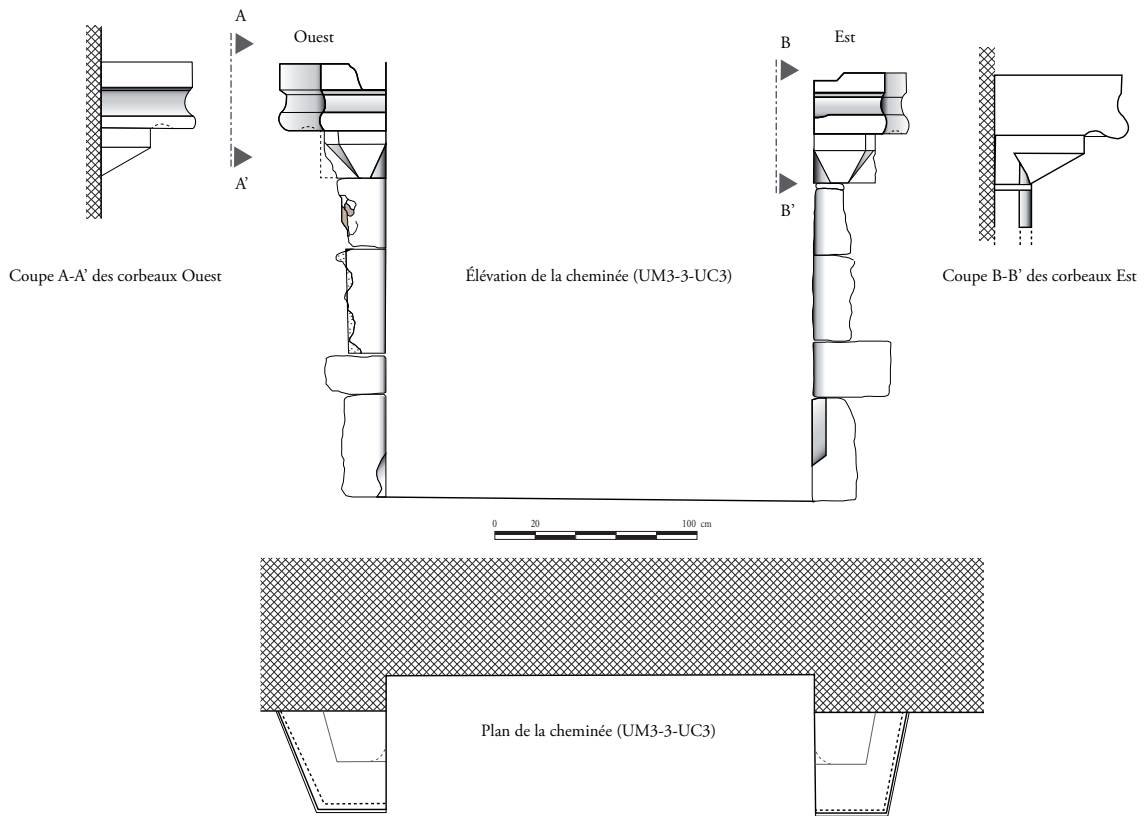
Plan, coupes et élévation de la cheminée UM3-3-UC3
